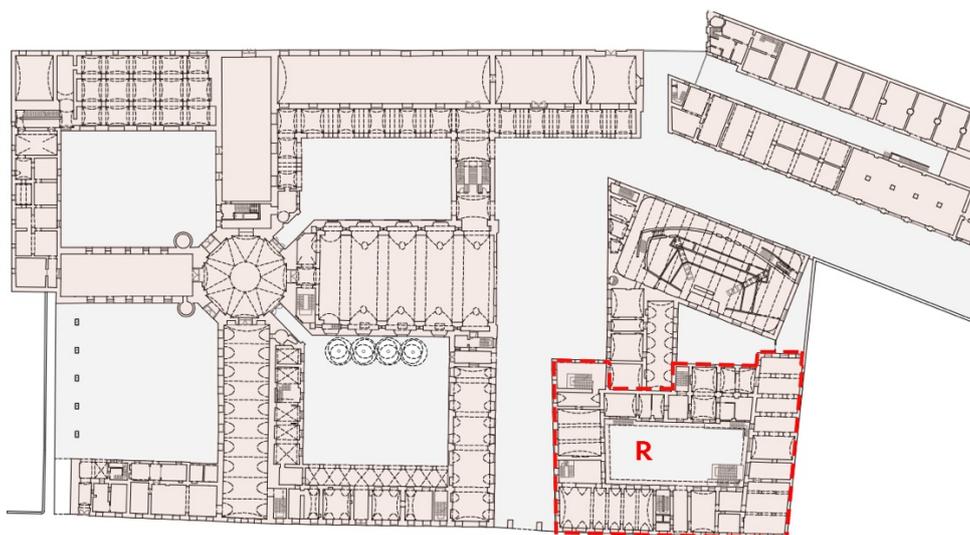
planimetria con evidenza edificio R– elaborazione personale
